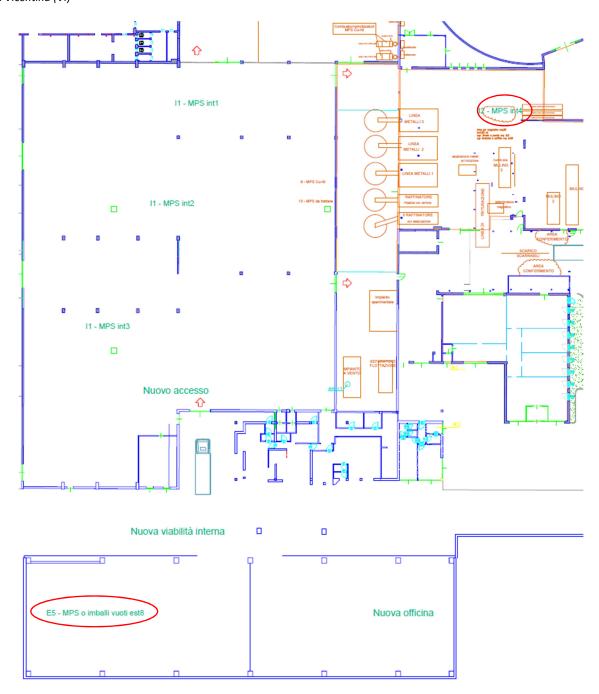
Planimetria delle nuove aree proposte per lo stoccaggio MPS (E5 ed I2)
